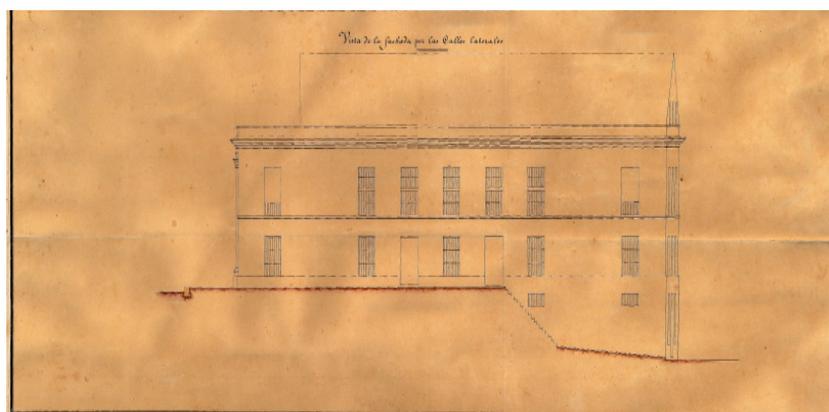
Detalle vista lateral (AHMM, Cuba 257-01).
